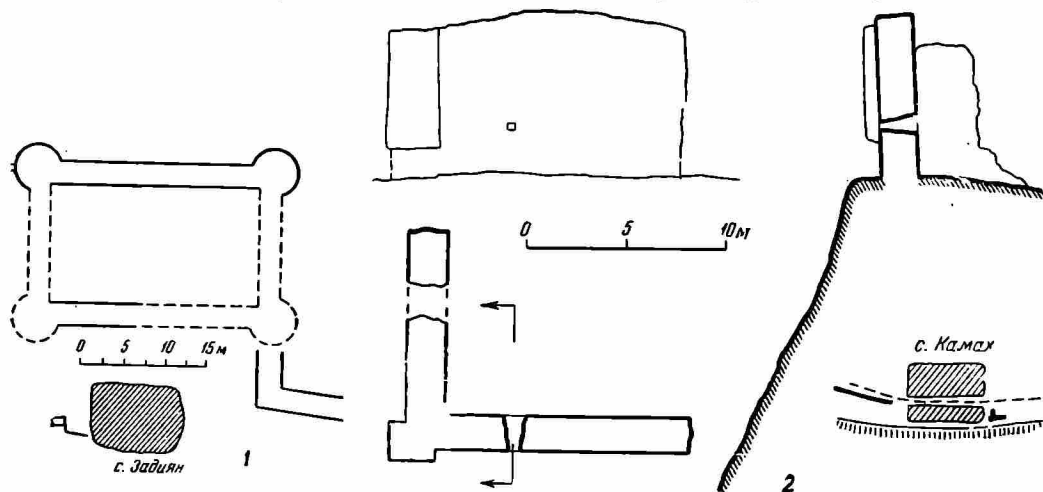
Остатки Горной стены у Задияна (1) и Камаха (2); схемы генпланов, планы, разрезы и фасад
